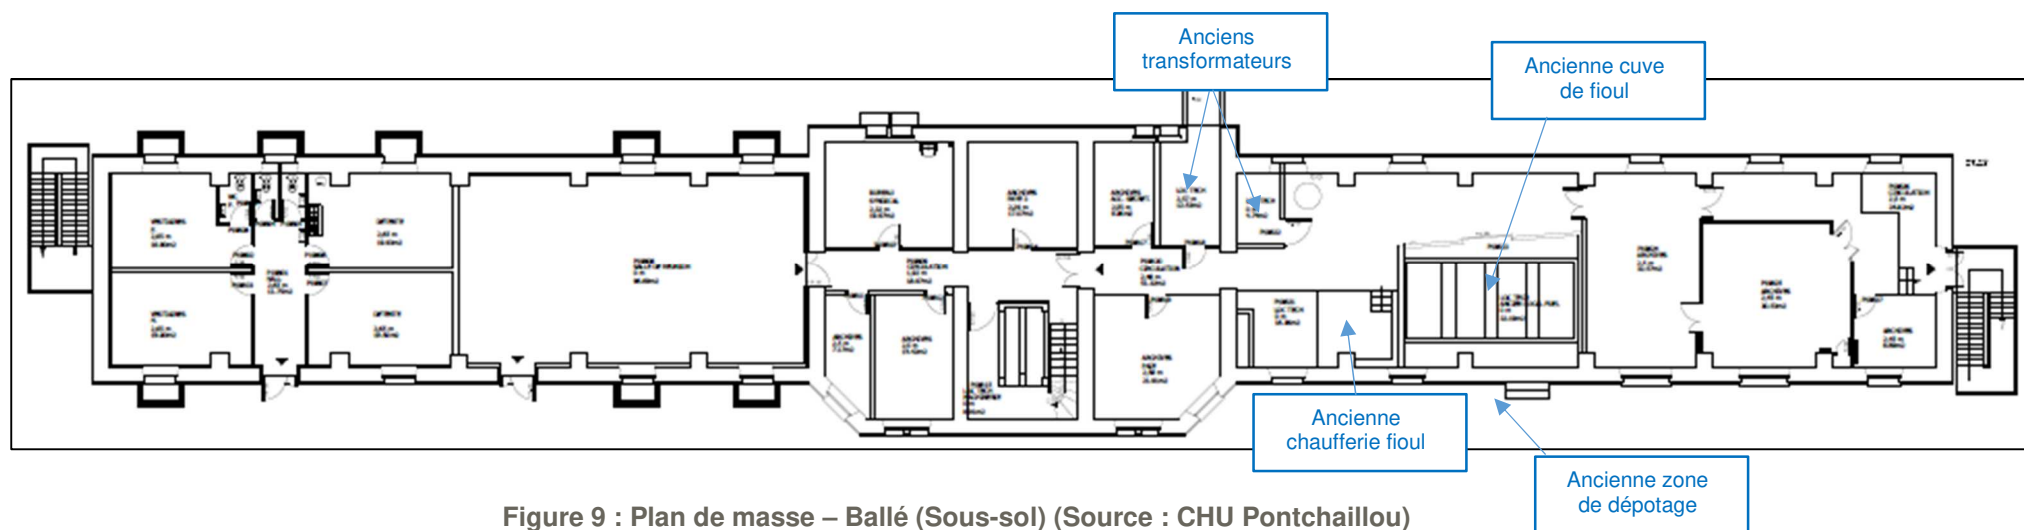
Plan de masse – Ballé (Sous-sol) (Source : CHU Pontchaillou)
